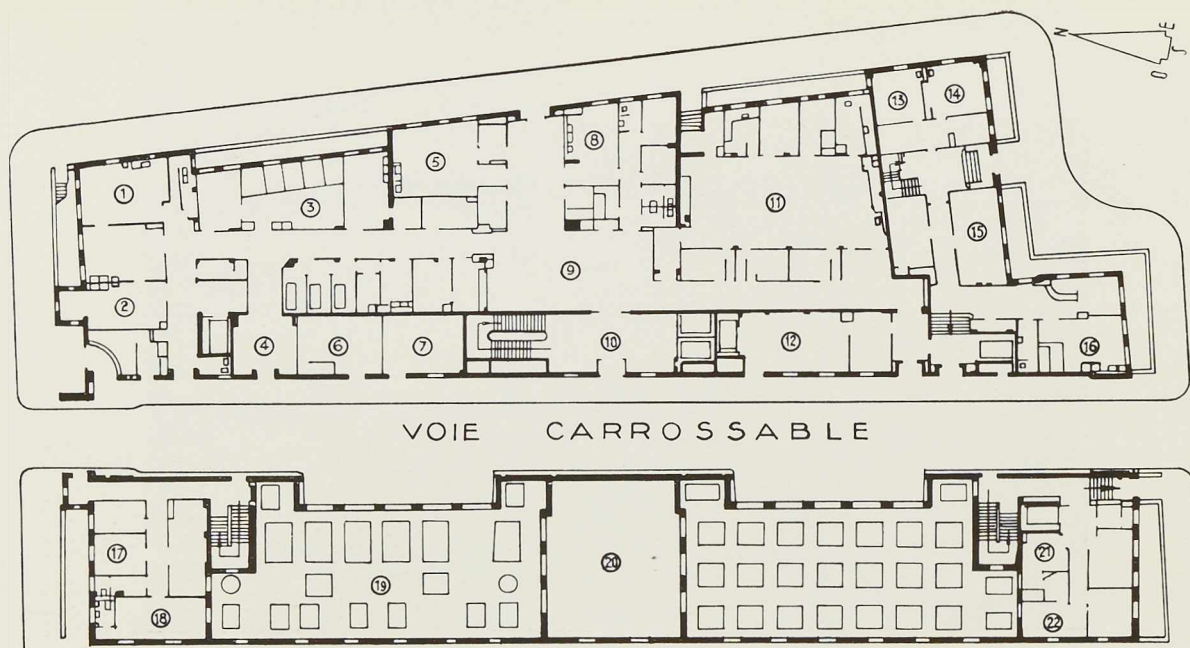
Plan du rez-de-chaussée de l'hôpital.
